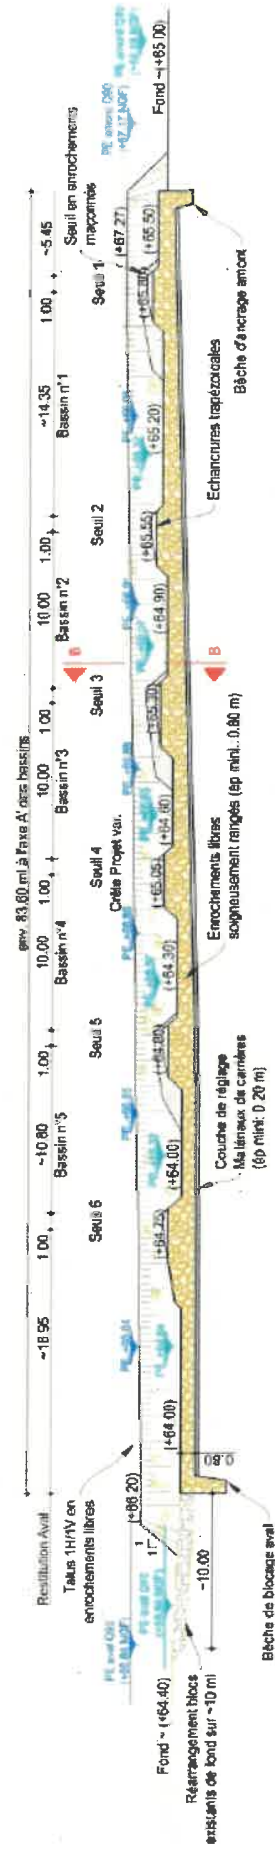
Coupe longitudinale du dispositif de franchissement (source : dossier d'autorisation)
